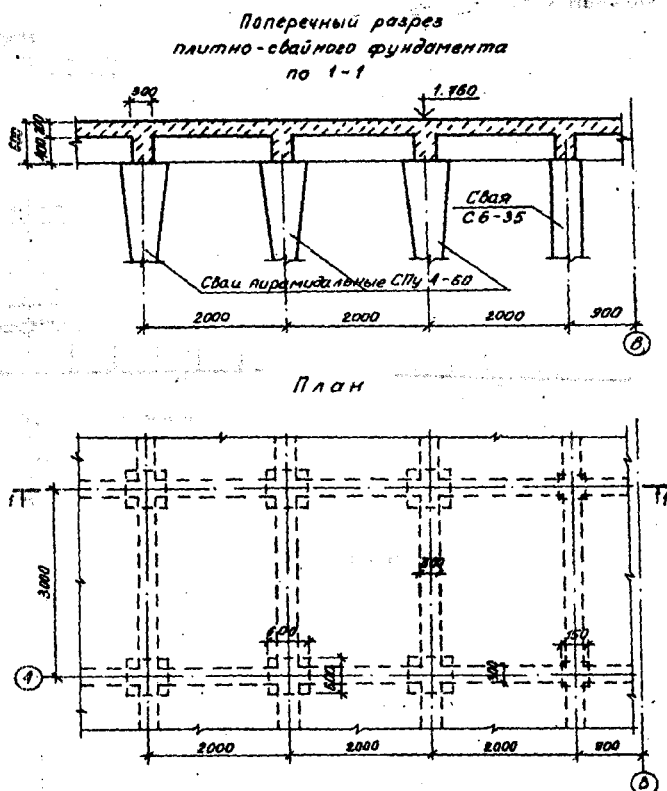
Конструктивное решение плитно-ребристого фундамента на пирамидальных сваях
